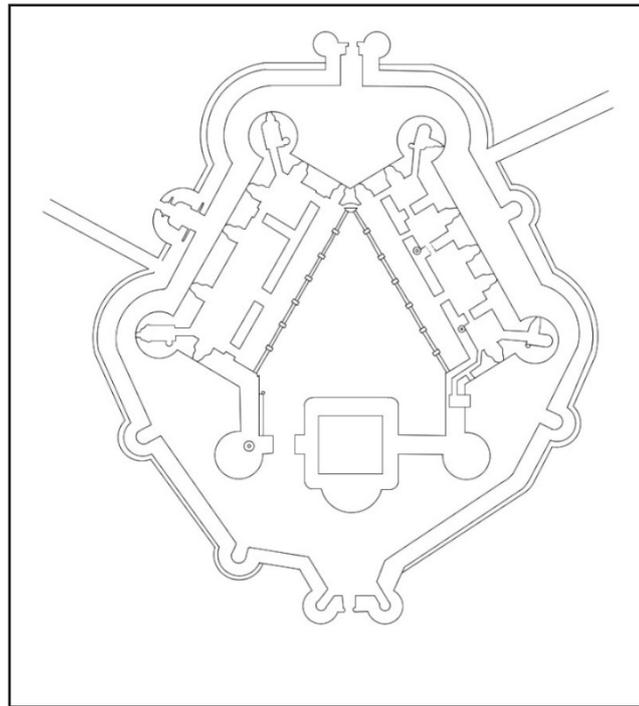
Planta de la primera planta del Castillo de Belmonte.
